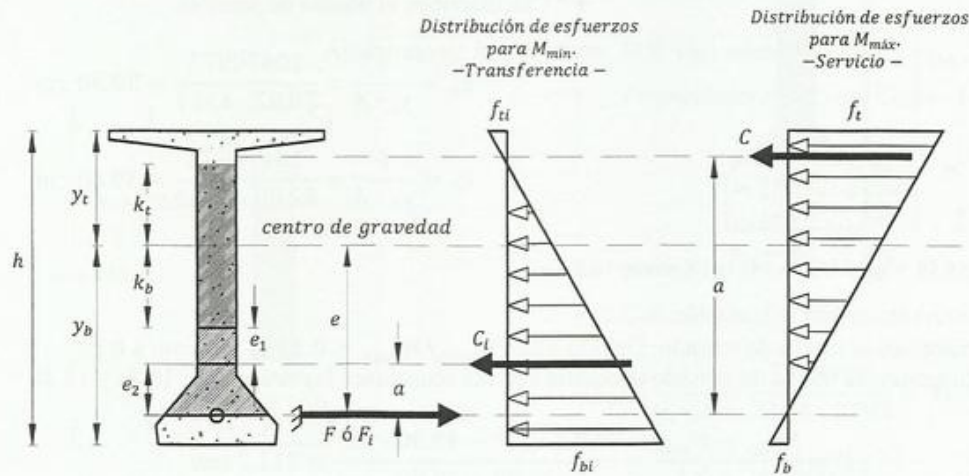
Diseño de vigas admitiendo tracciones en el concreto
